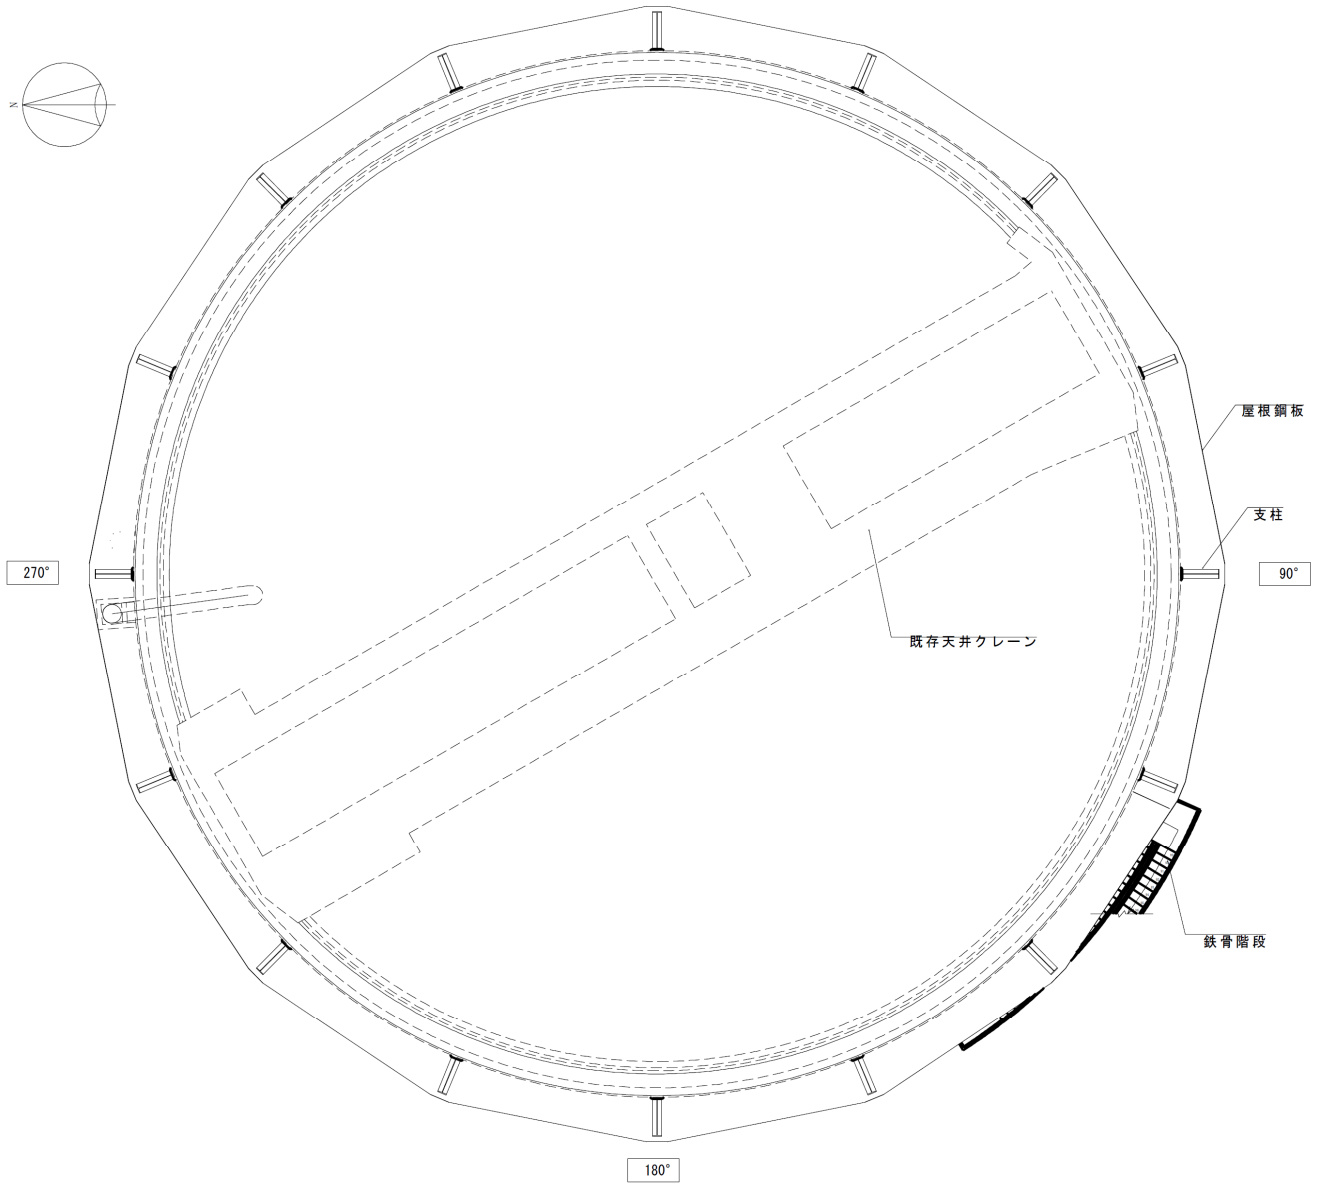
原子炉建家クレーンレベル平面図 (FL+19,000)
